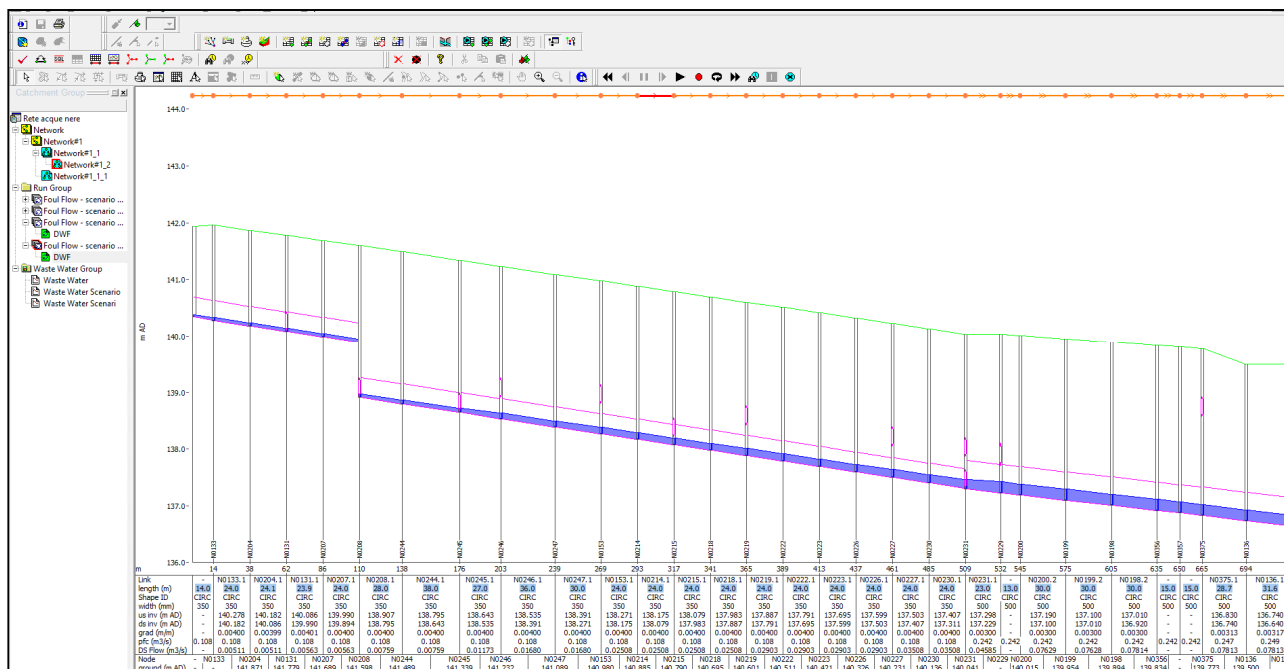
Profilo longitudinale tratto di rete Decumano sud
